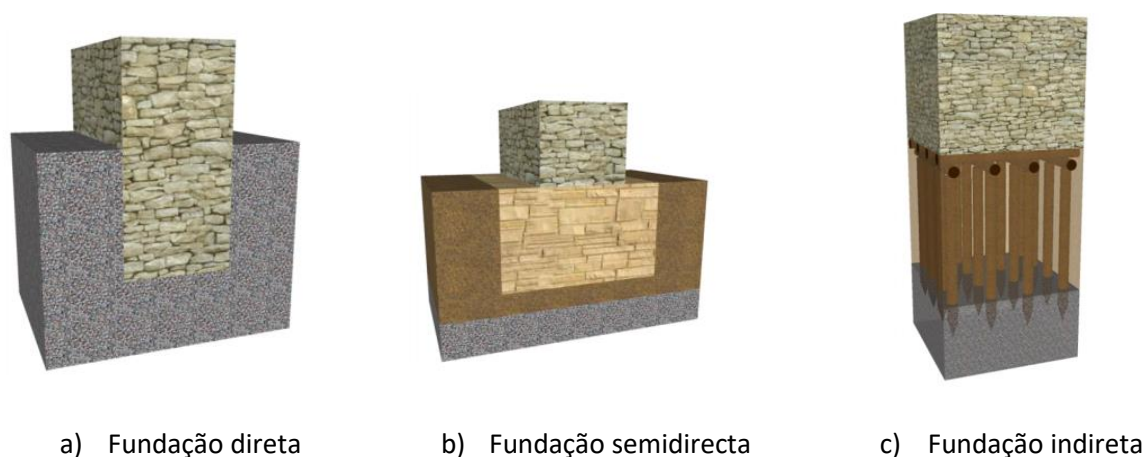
Tipos de fundações (Moreira, 2009)
